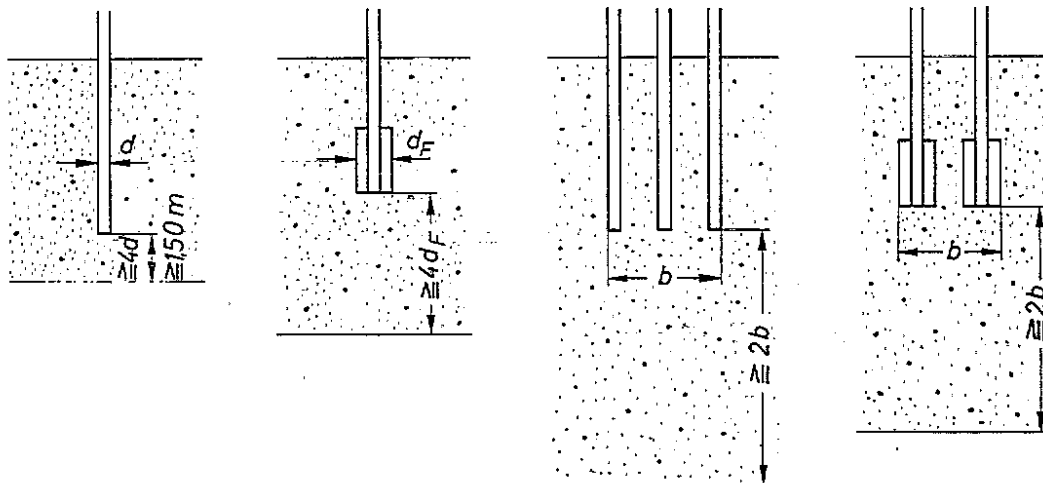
Erforderliche Tiefe des tragfähigen Baugrundes
